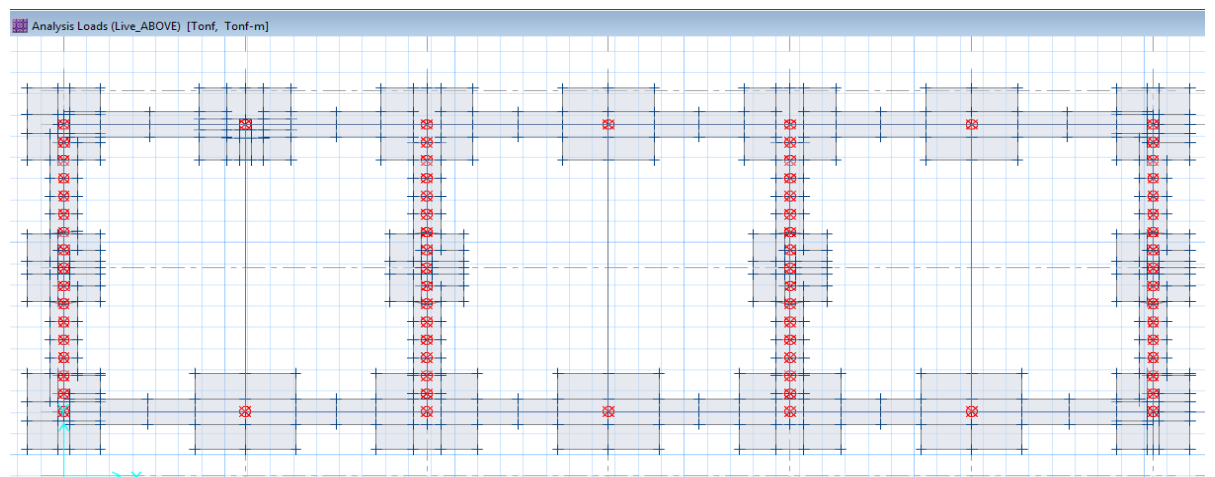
Planta y elevación cimentación de Módulo II y V
